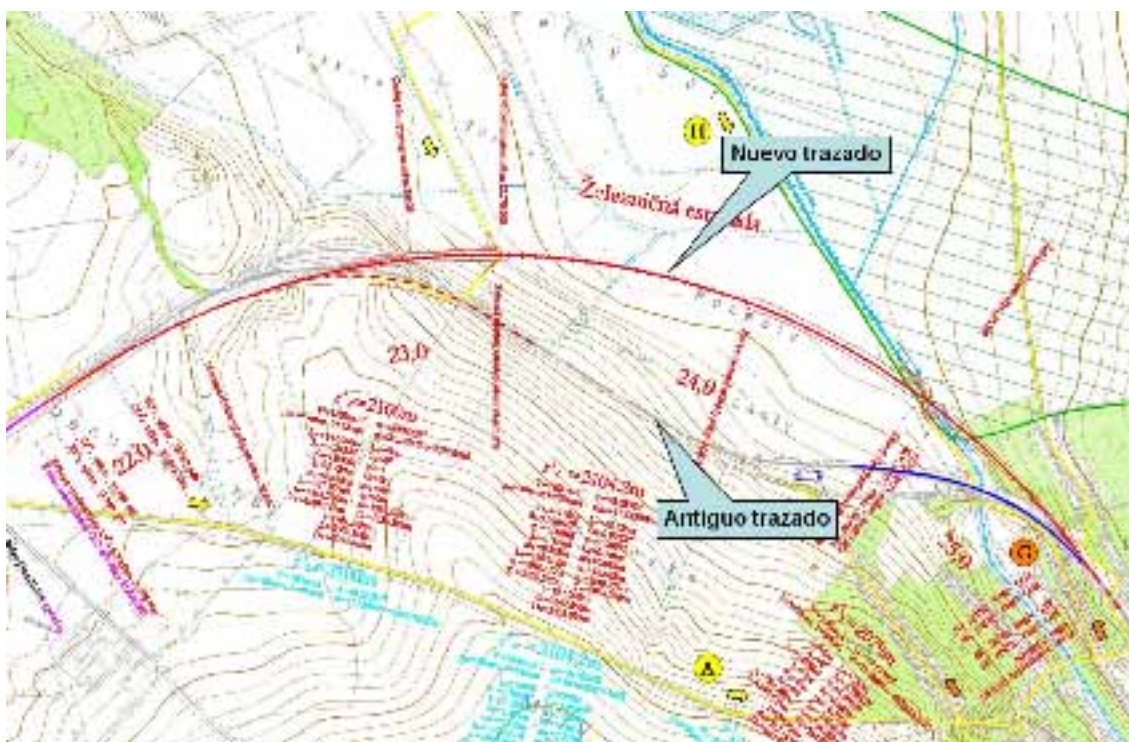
Planta trazados ferrocarril (tramo de Senkvice)
